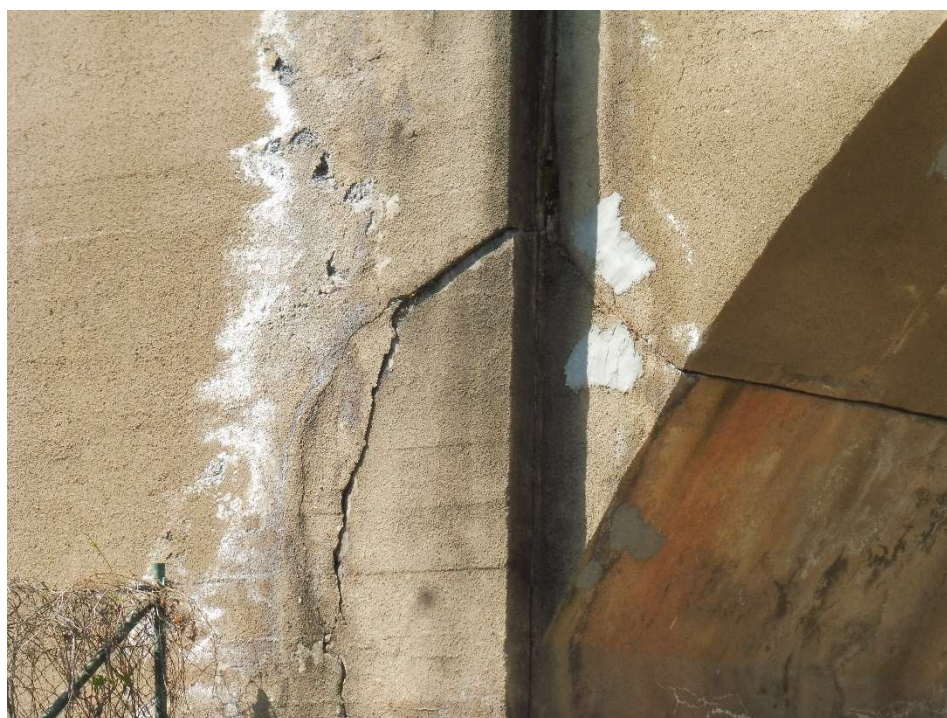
Betonschäden am Bauwerk (Stand: 05.2024)
